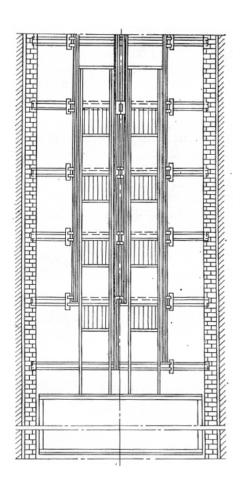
Схема жесткого крепления люлек к верхнему этажу подвесного полка
